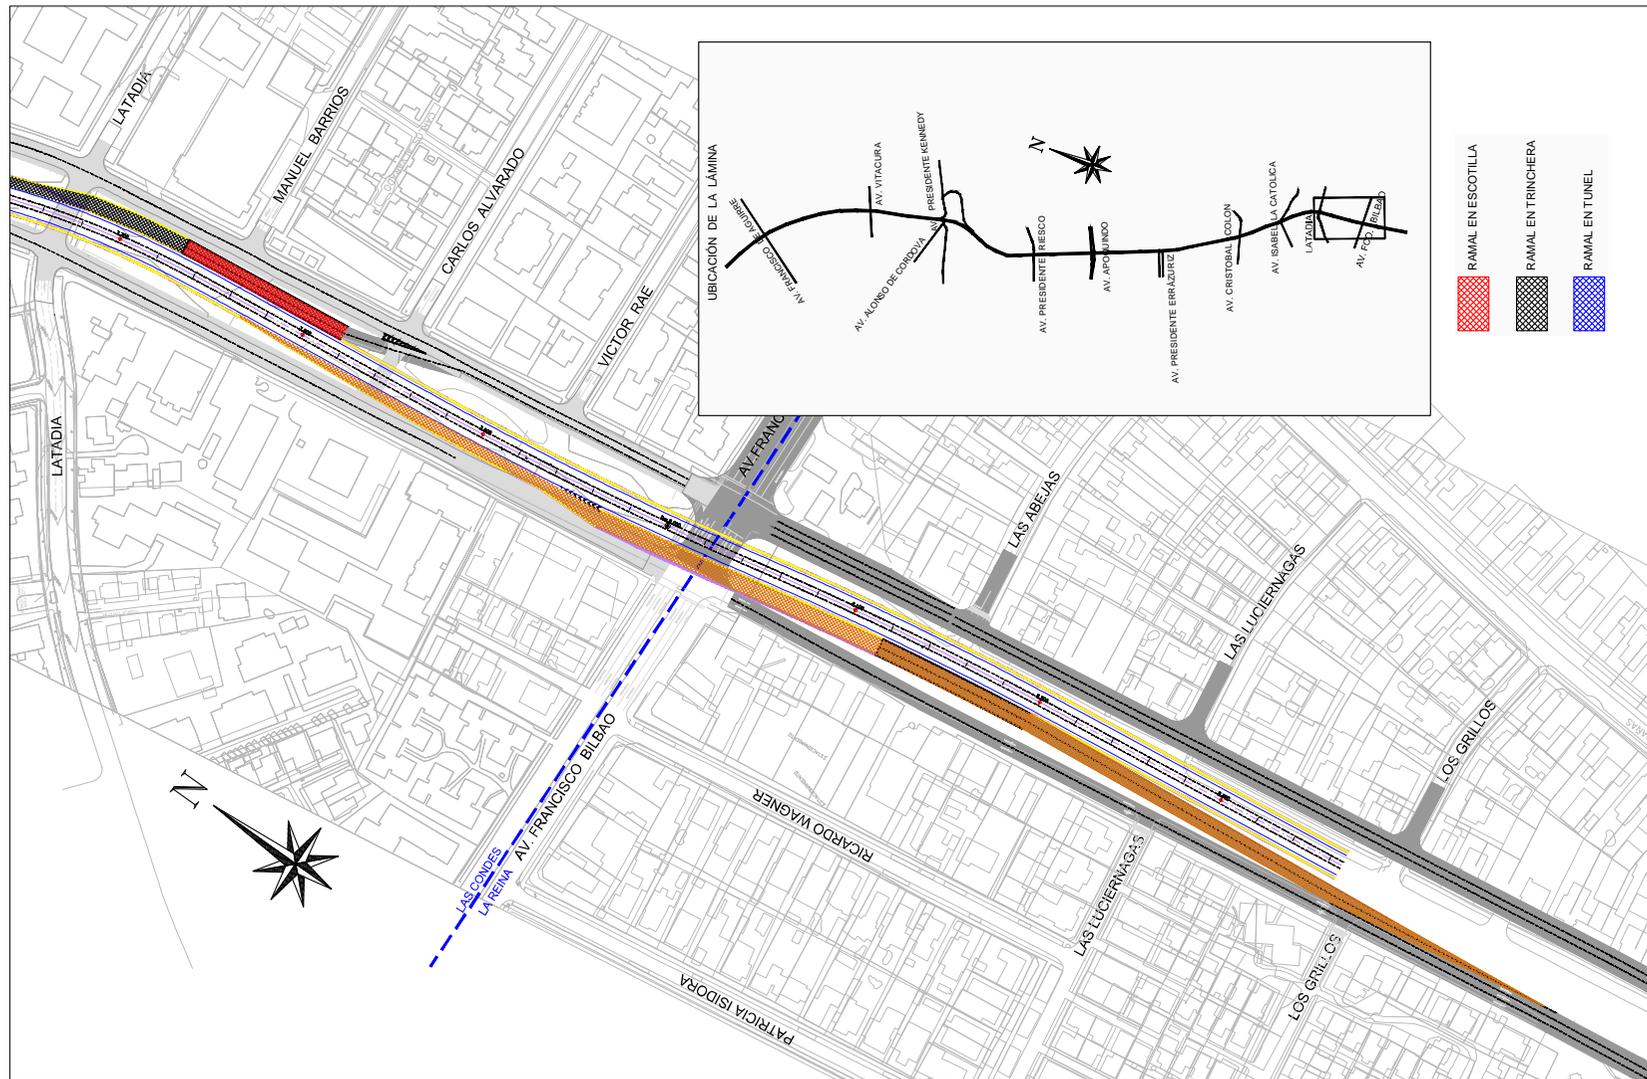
Conexión de Término Sur de la Concesión hacia la Calzada Local Américo Vespucio sentido Norte Sur DM 7.960
